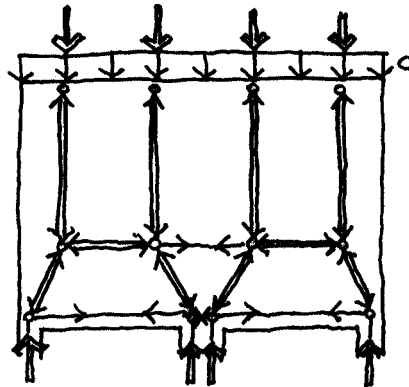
Planteamiento de las condiciones de equilibrio en una estructura completa
